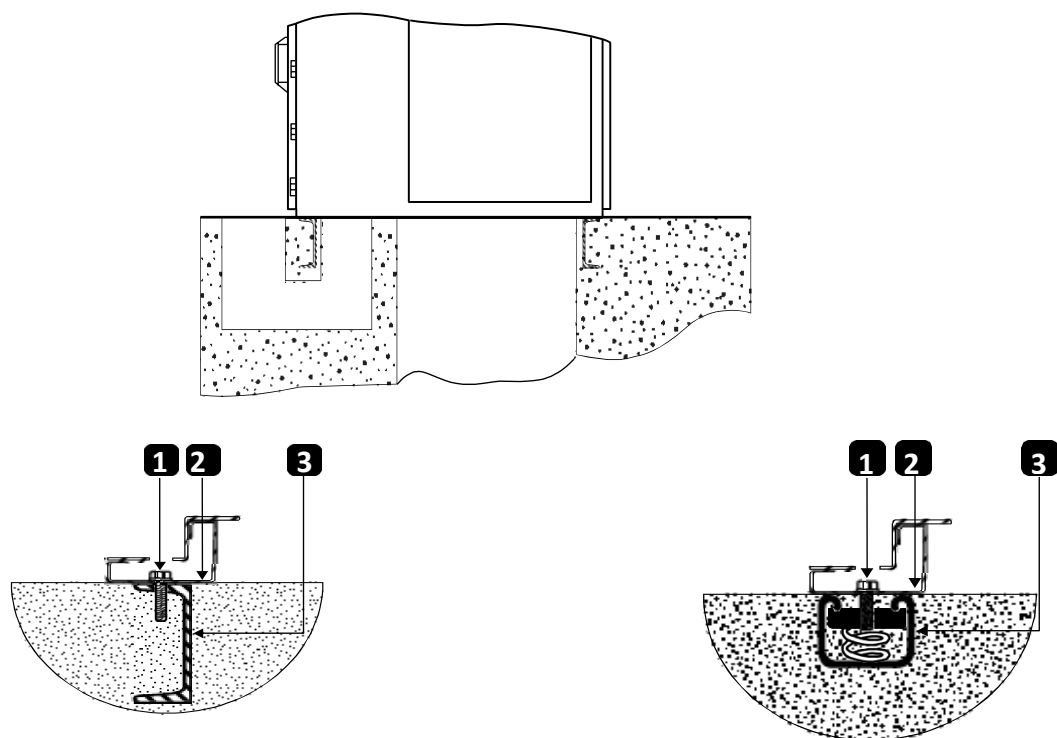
Монтаж УПП на бетонный пол, где
